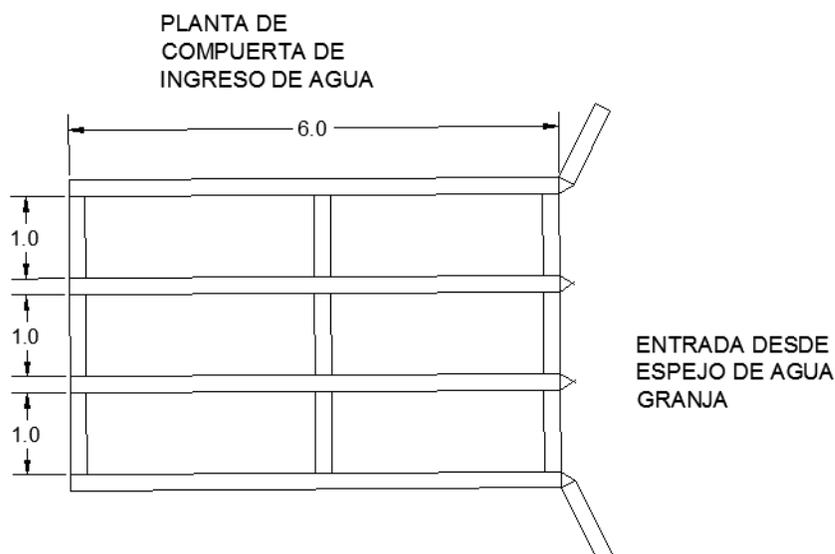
Tipo de estructura de las compuertas para la entrada y descargas de las aguas del estanque.
